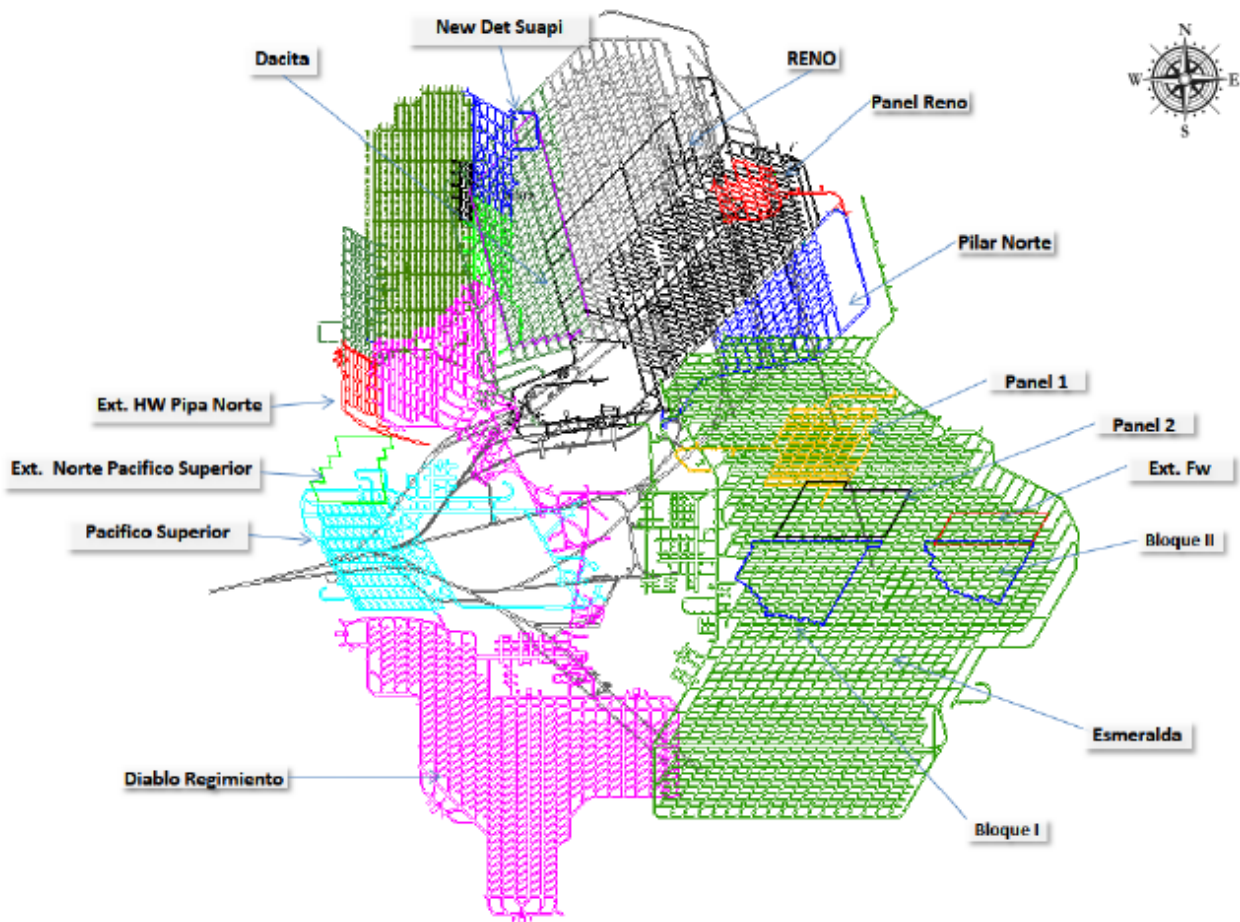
Disposición de sectores mina El Teniente, vista en planta (Codelco División El Teniente, 2017)
